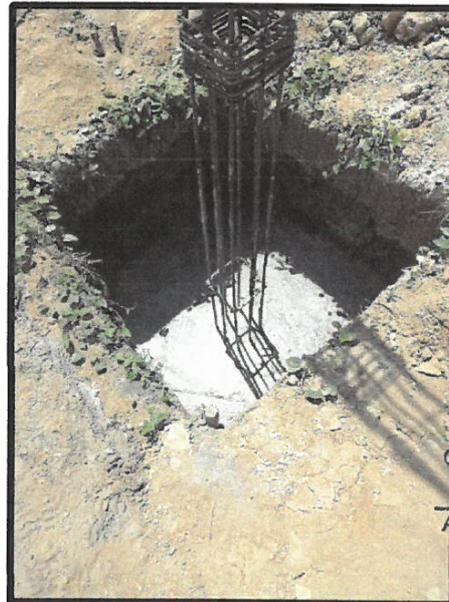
ZAPATA Z-1 VACIADA Y COLUMNA C-1 MODULO 1 EJE 7-C
